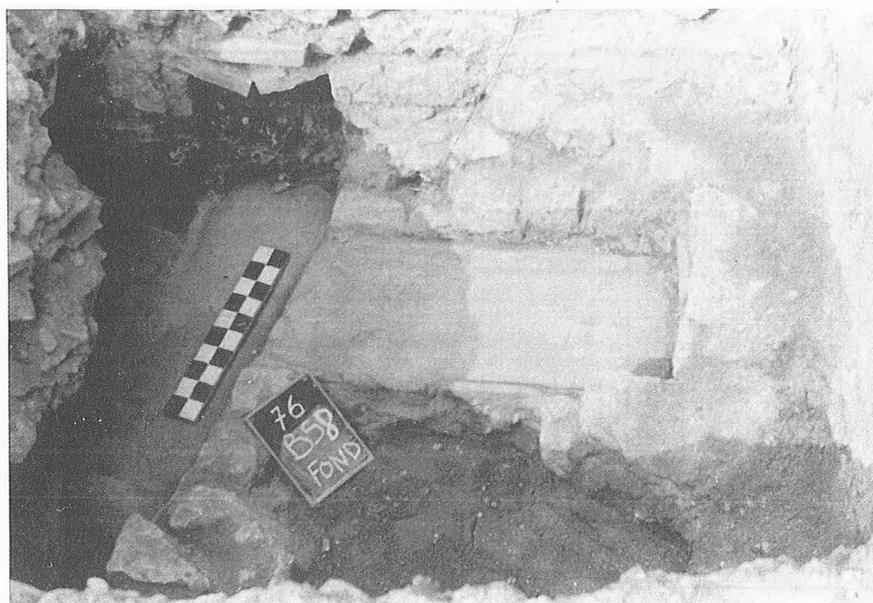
Canalisation 7 sous les sols de la salle 19.
